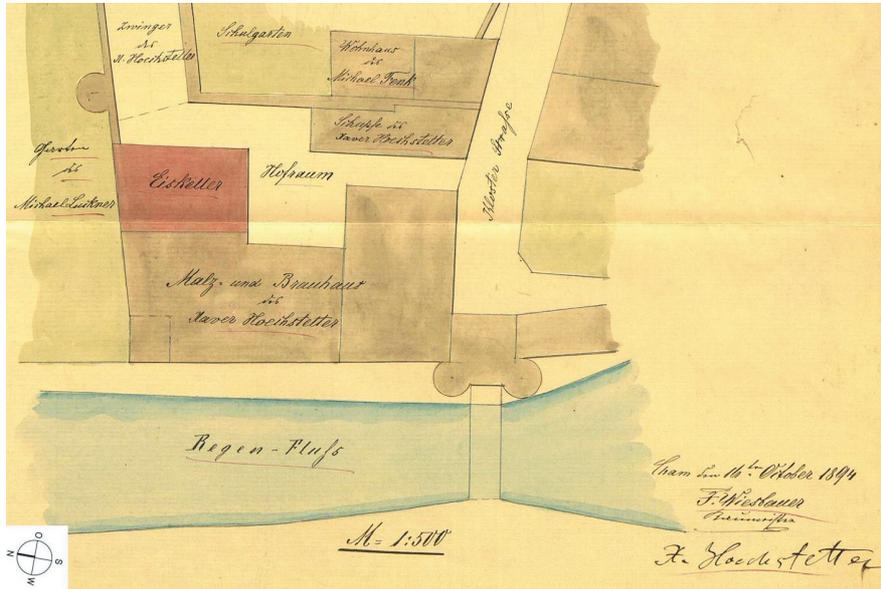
Lageplan der Höchstetterbrauerei für die Vergrößerung der Malz-Tenne aus dem StAAm/Bezirksamt Landratsamt Cham, Baugenehmigungsakte 134/1894 (Bereich des Umbaus ist rot eingefärbt)
